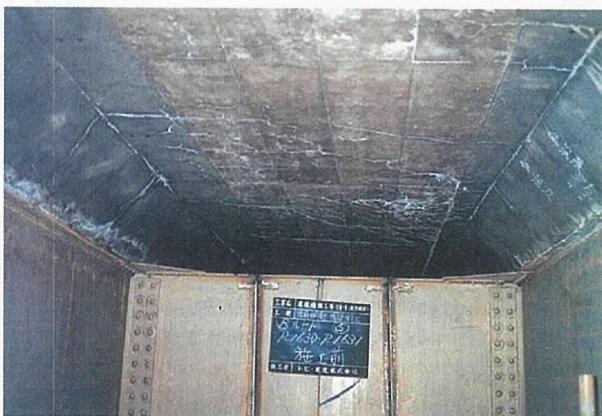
コンクリート床版に発生したひび割れ損傷
